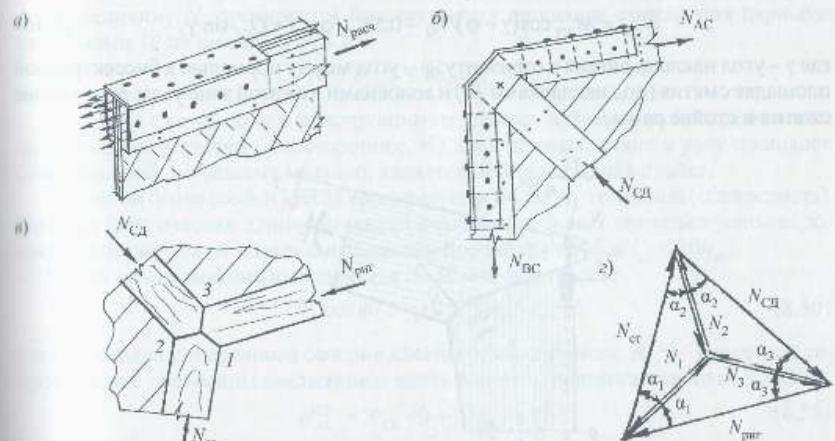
Фрагменты узла: а – П-образная металлическая накладка, б – упор диагонального ребра в накладку; в – трехлобовой упор; г – силовой многоугольник
